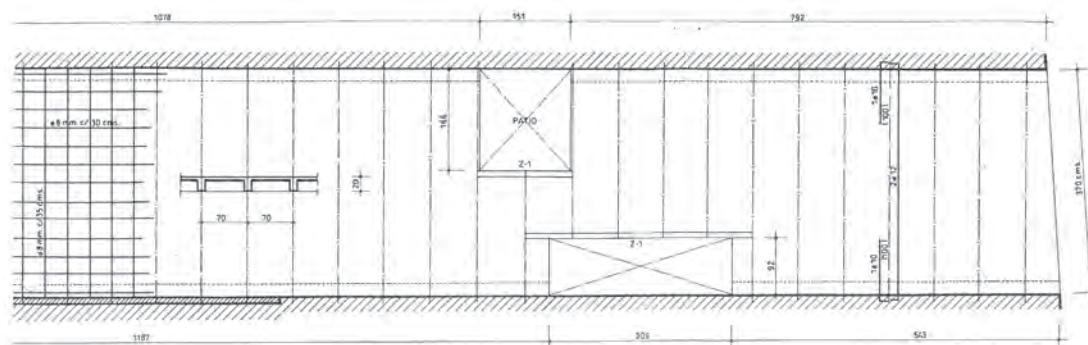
20. 1997 REFUERZO ESTRUCTURAL EN FORJADO DE PLANTA BAJOCUBIERTA
